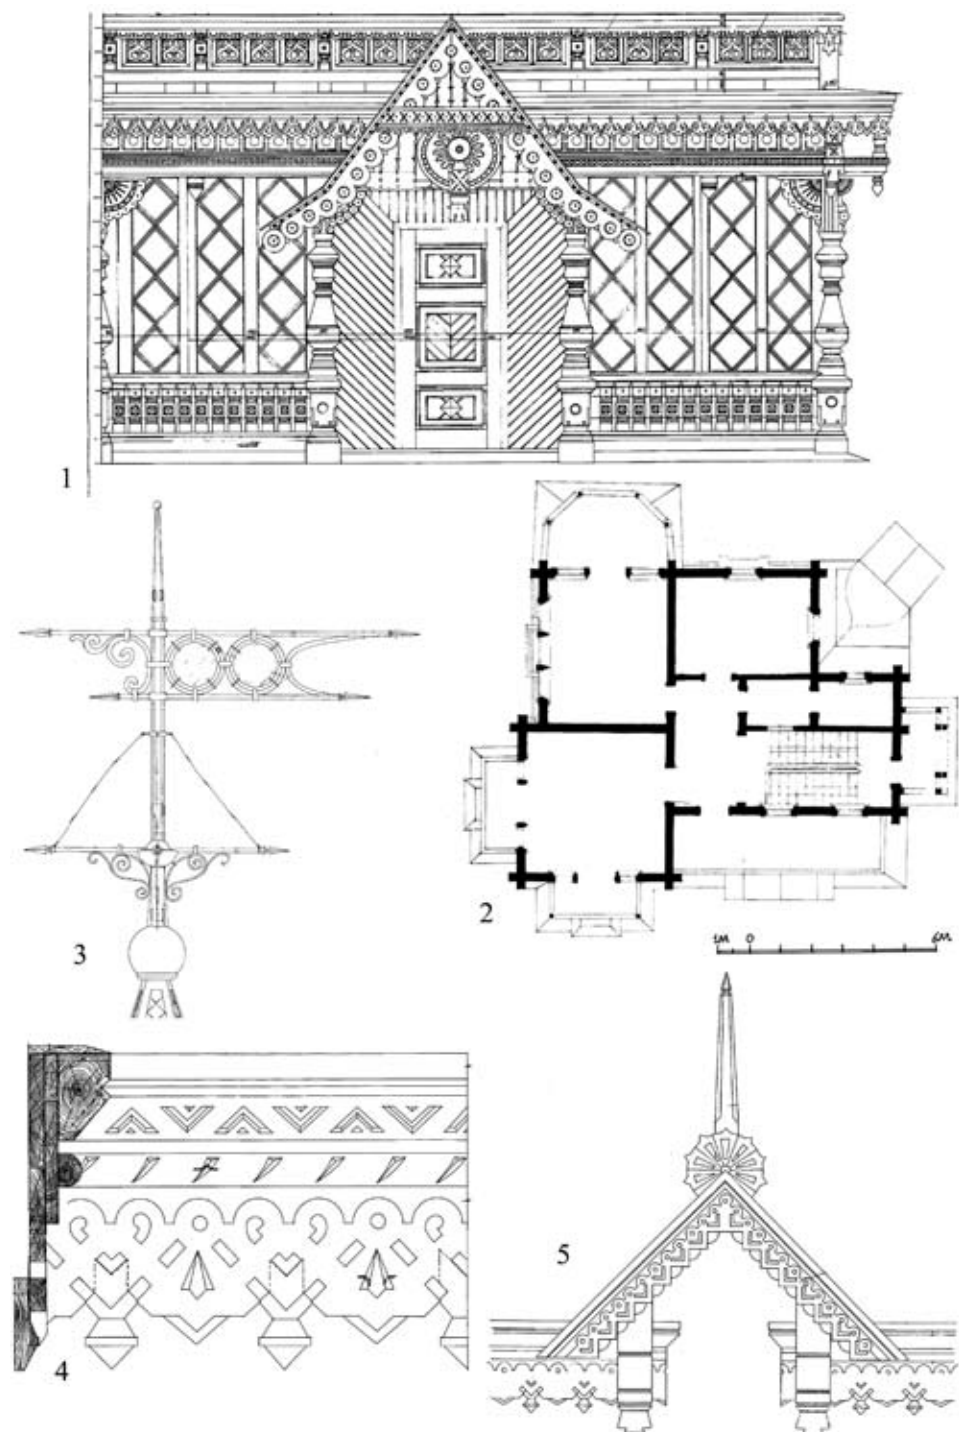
Летняя дача Бугрова: 1 – веранда северного фасада; 2 – план 2-го этажа; 3 – флюгер главной башни; 4 – фрагмент главного карниза; 5 – завершение наличника окна. Проект реставрации, 2008 г.
